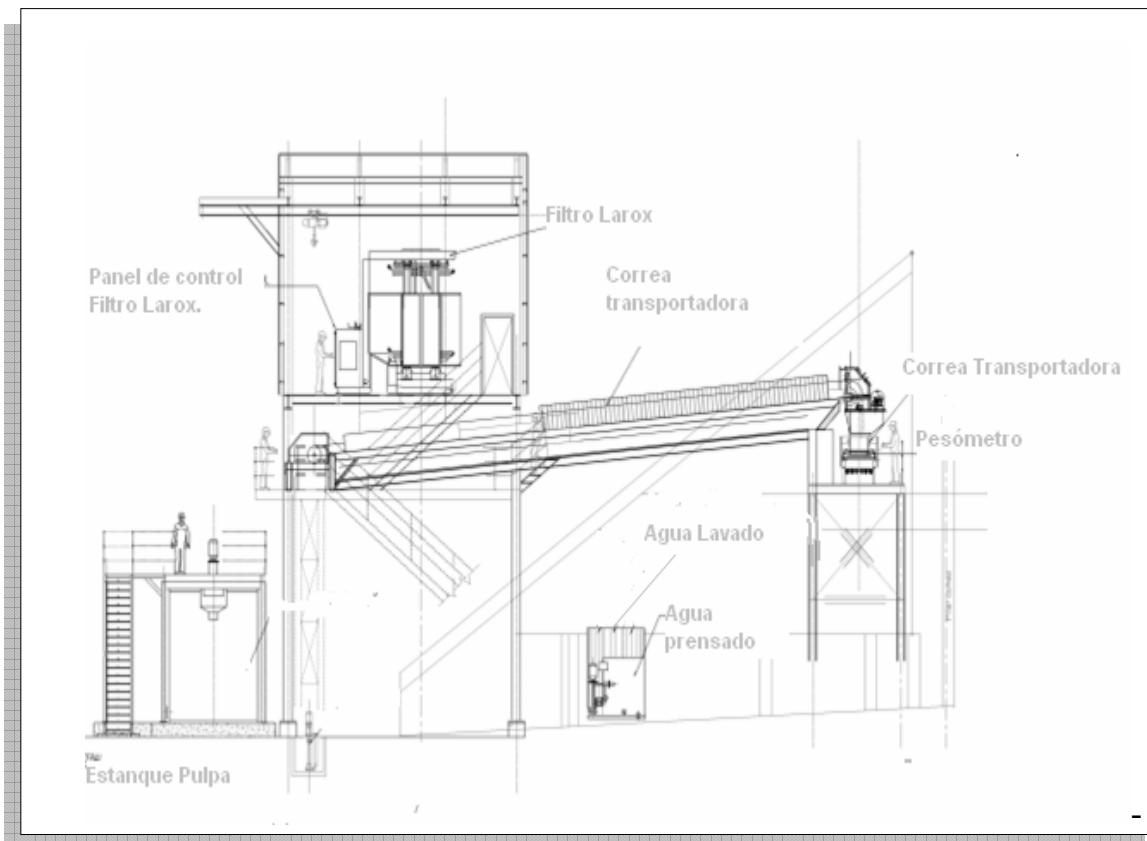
Vista frontal filtro Larox, planta Las Tórtolas Anglo American Chile.
